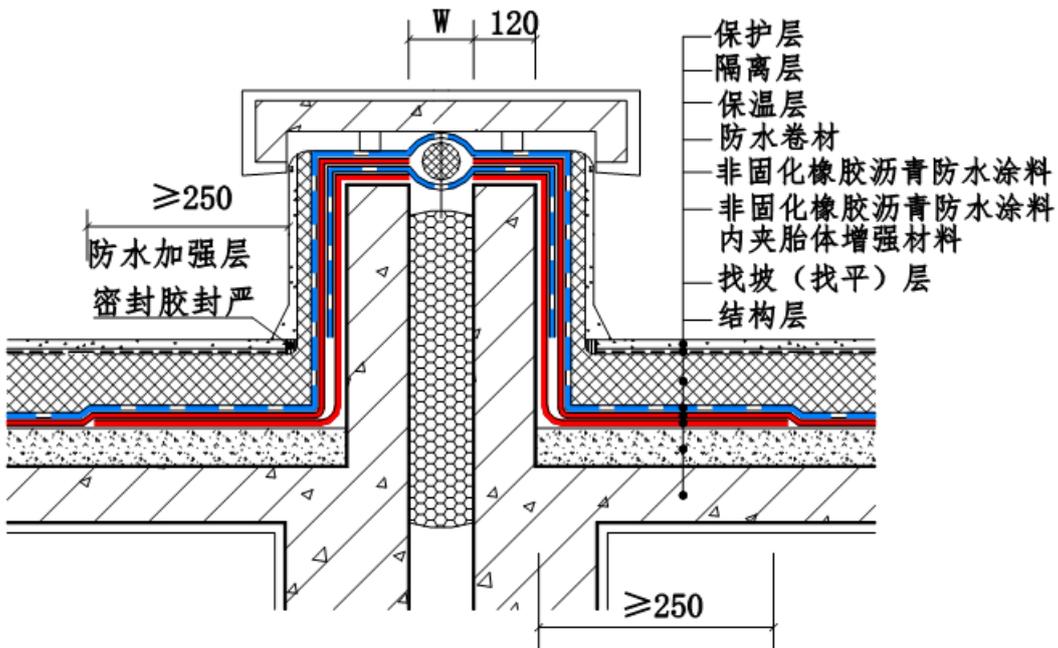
倒置式混凝土盖板等高变形缝防水构造
